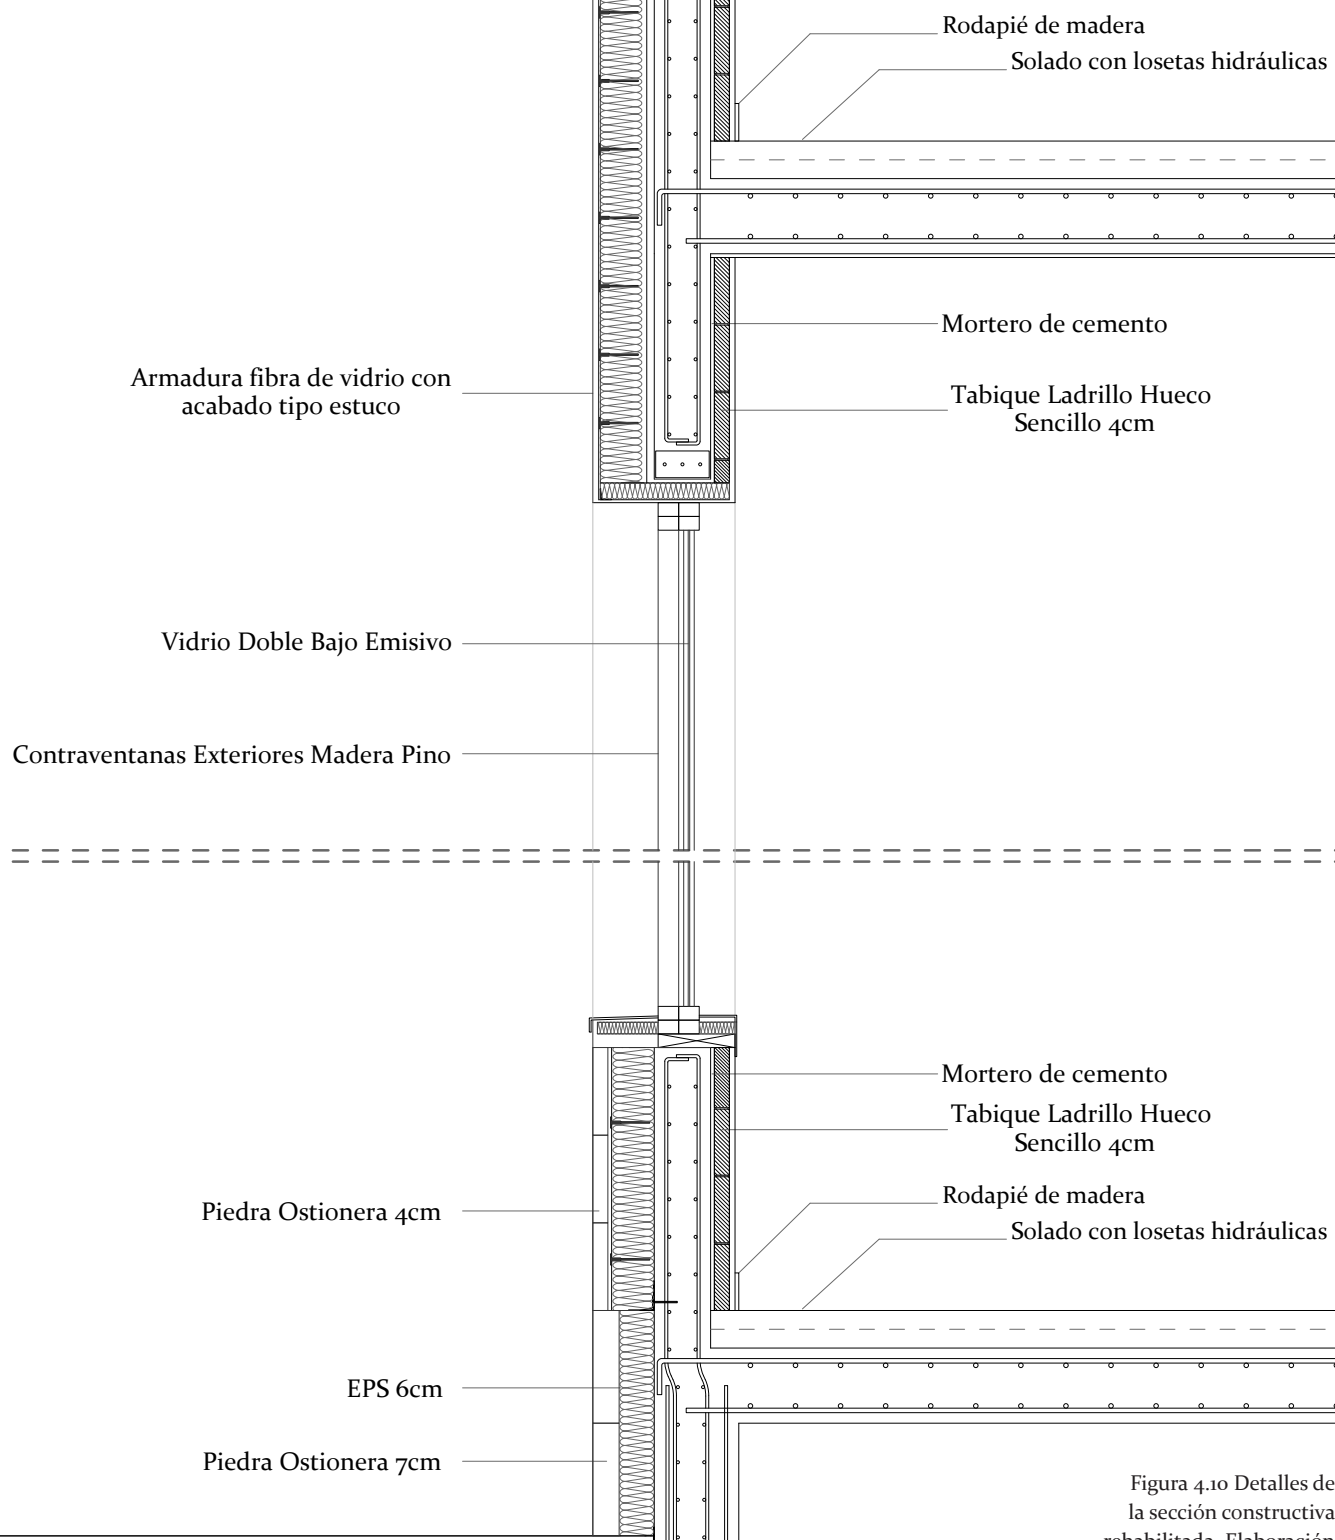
Detalles de la sección constructiva rehabilitada. Elaboración propia a partir del proyecto de ejecución.
